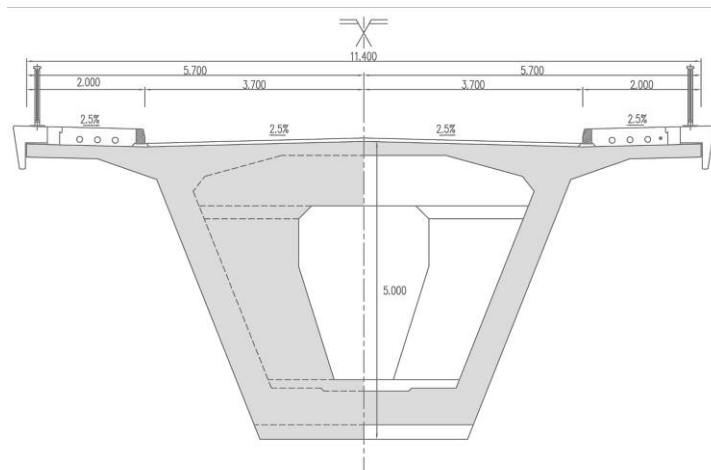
Corte transversal do tabuleiro sobre o apoio nos pilares
